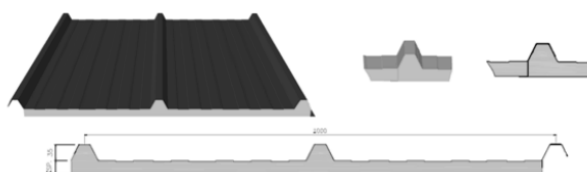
Sistema construtivo da cobertura do tipo sandwich (adaptado de Mundiperfil)
